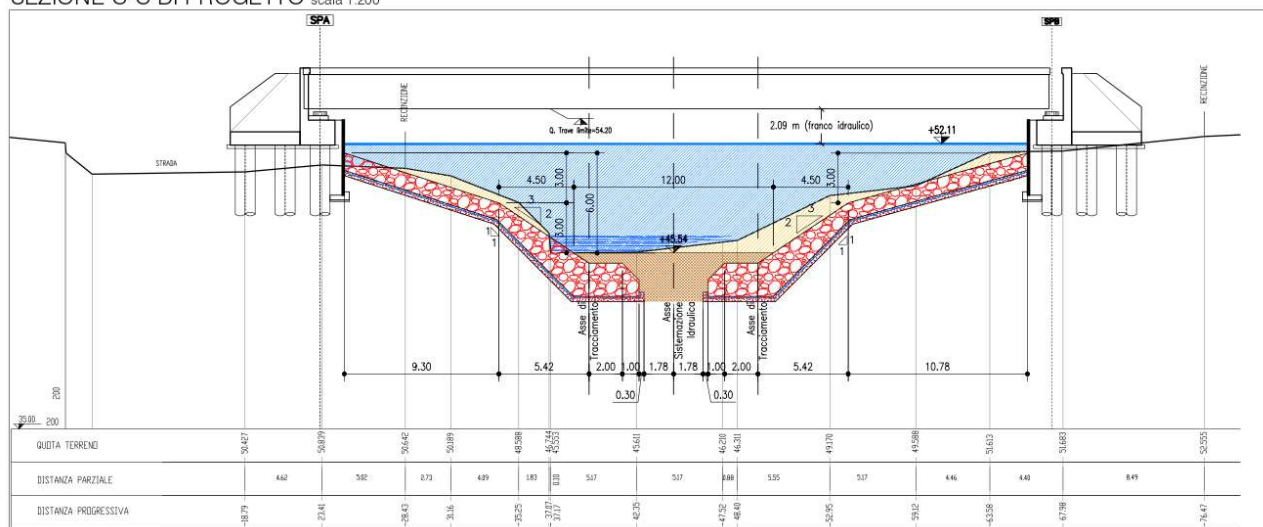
Sezione d'alveo ripristinato con protezione spondale in massi intasati in terra
